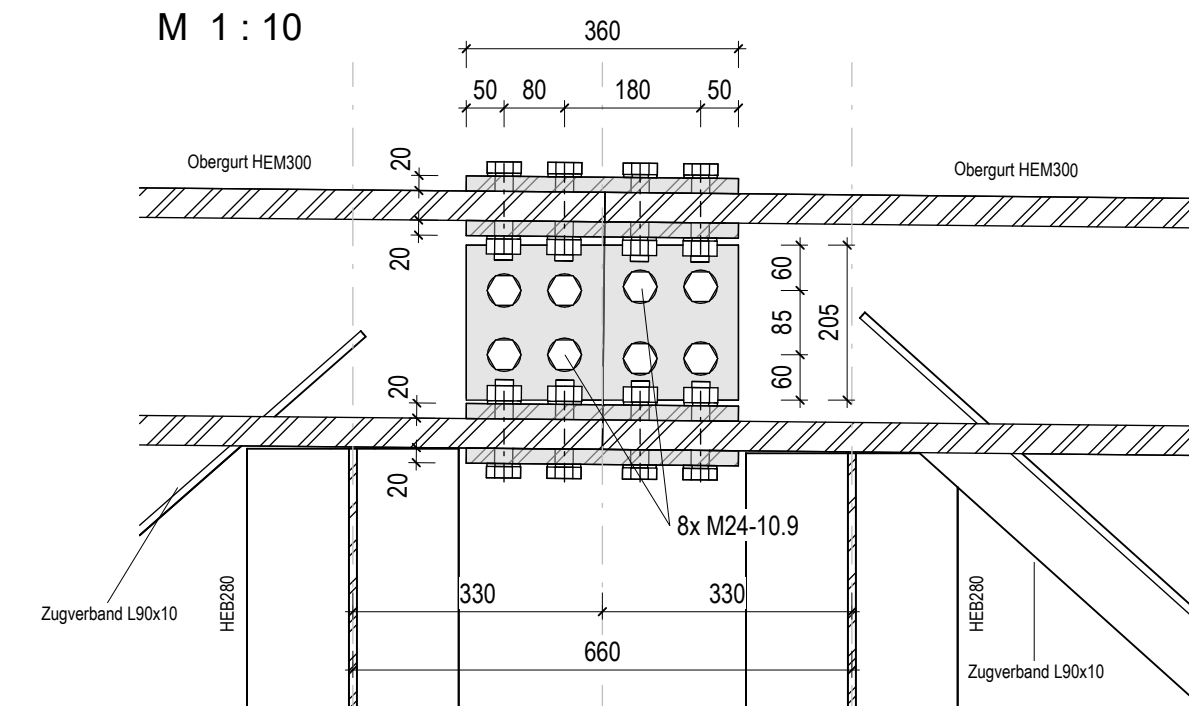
Laschenstoß Obergurt- Längsträger HEM300
